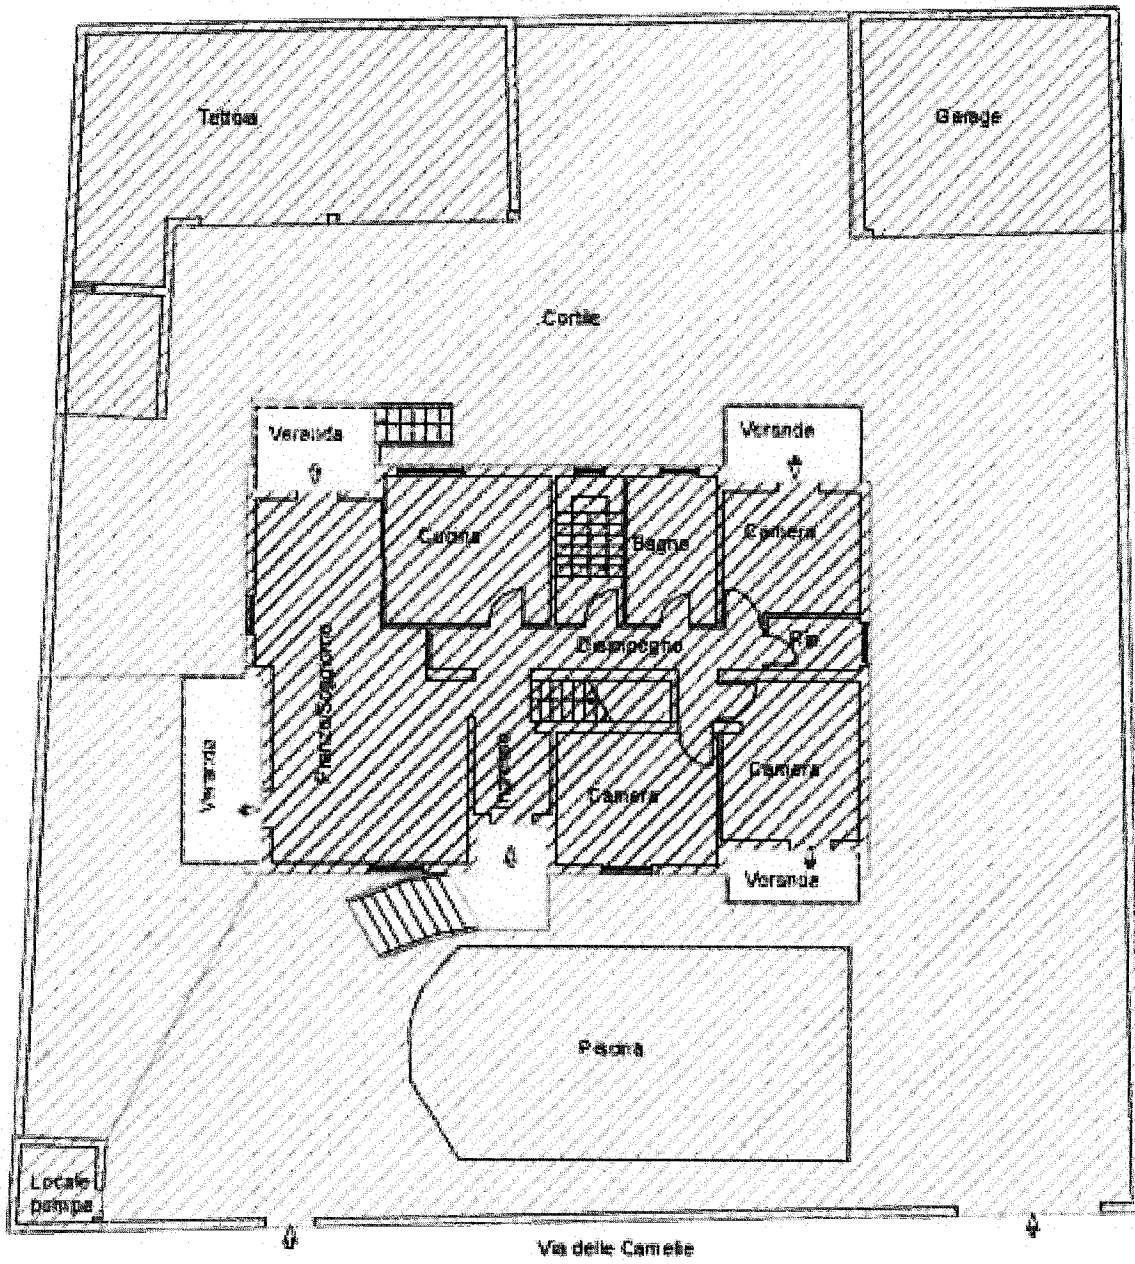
Planimetria Piano Terra –calcolo Superficie commerciale
